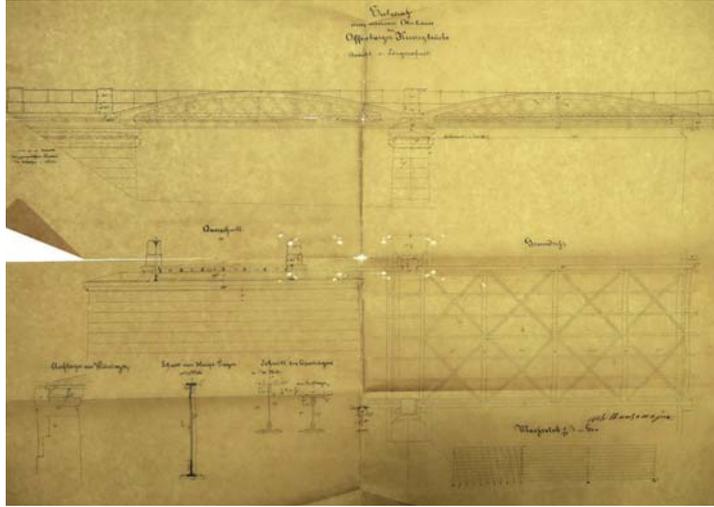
Entwurf einer Kinzig-Straßenbrücke, Planzeichnung, 1873_ StA-OG_5-9.617
